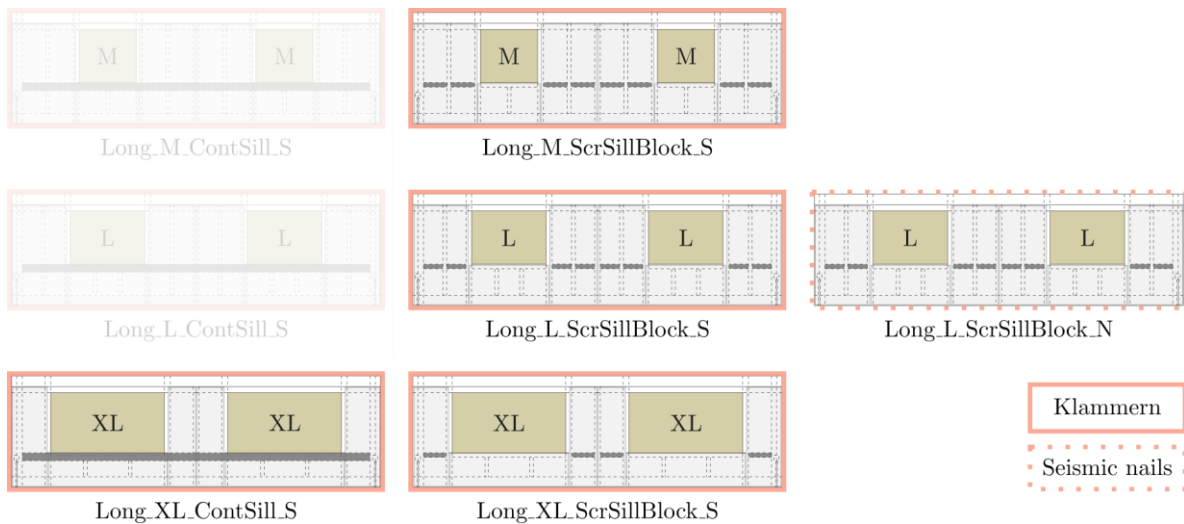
Konfigurationen mit langen, eingeschossigen Wandelementen, welche im AP 5 experimentell untersucht wurden.
